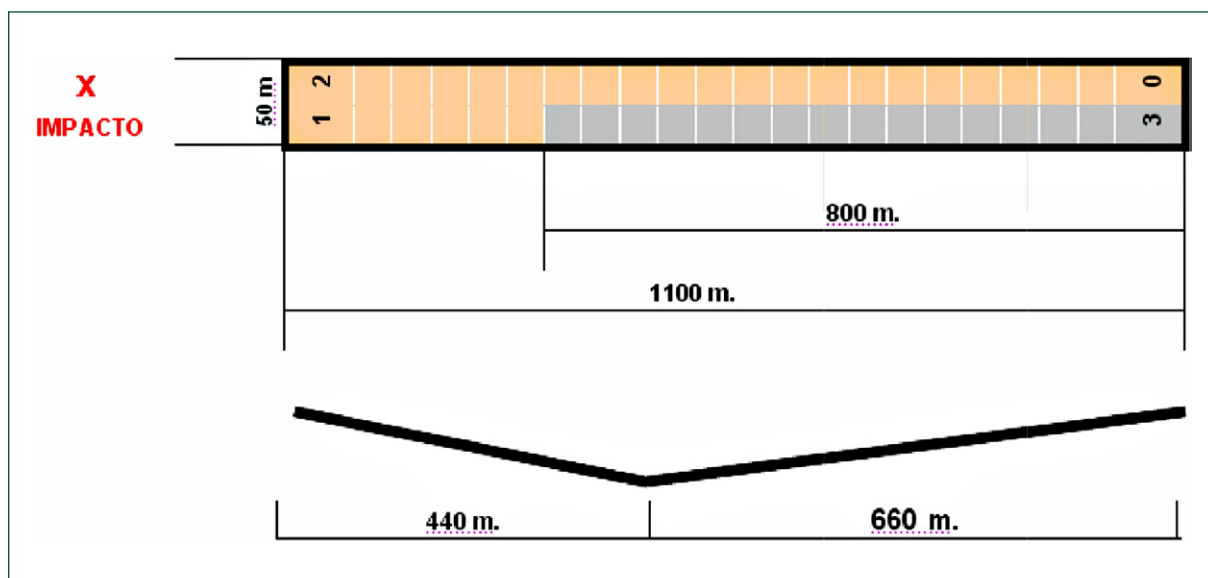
Planta y perfil de la pista 12-30 y punto de impacto
